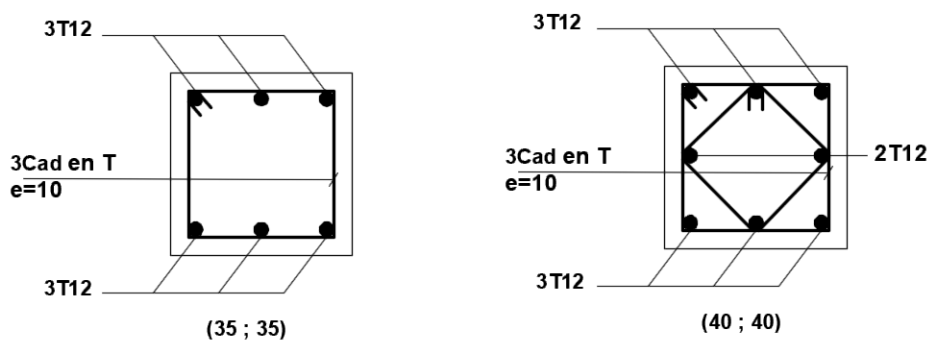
ferrailage des poteaux 35x35 ; 40x40
